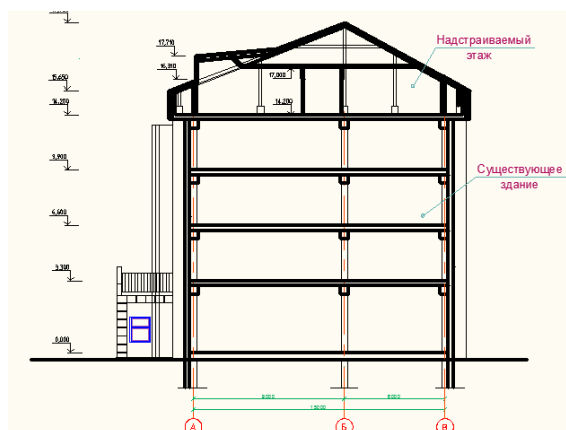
Главный фасад здания Верховного Суда КР (после реконструкции, проектное решение)
